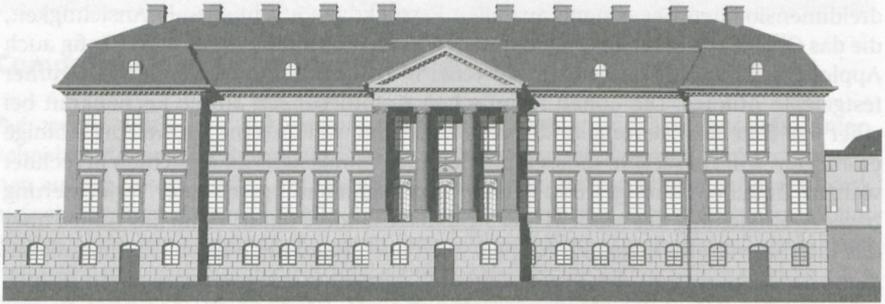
Alternative Rekonstruktion der Dachgauben. Dachvariante vor und nach dem Umbau im 19. Jahrhundert, Version Februar 2015, Jan Lutteroth
